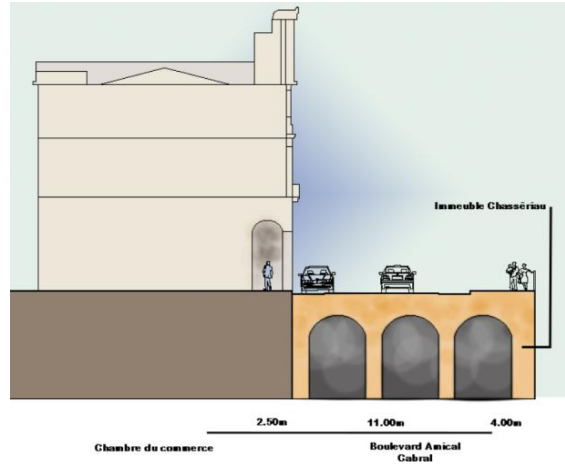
Coupe sur boulevard Amilcar Cabral
